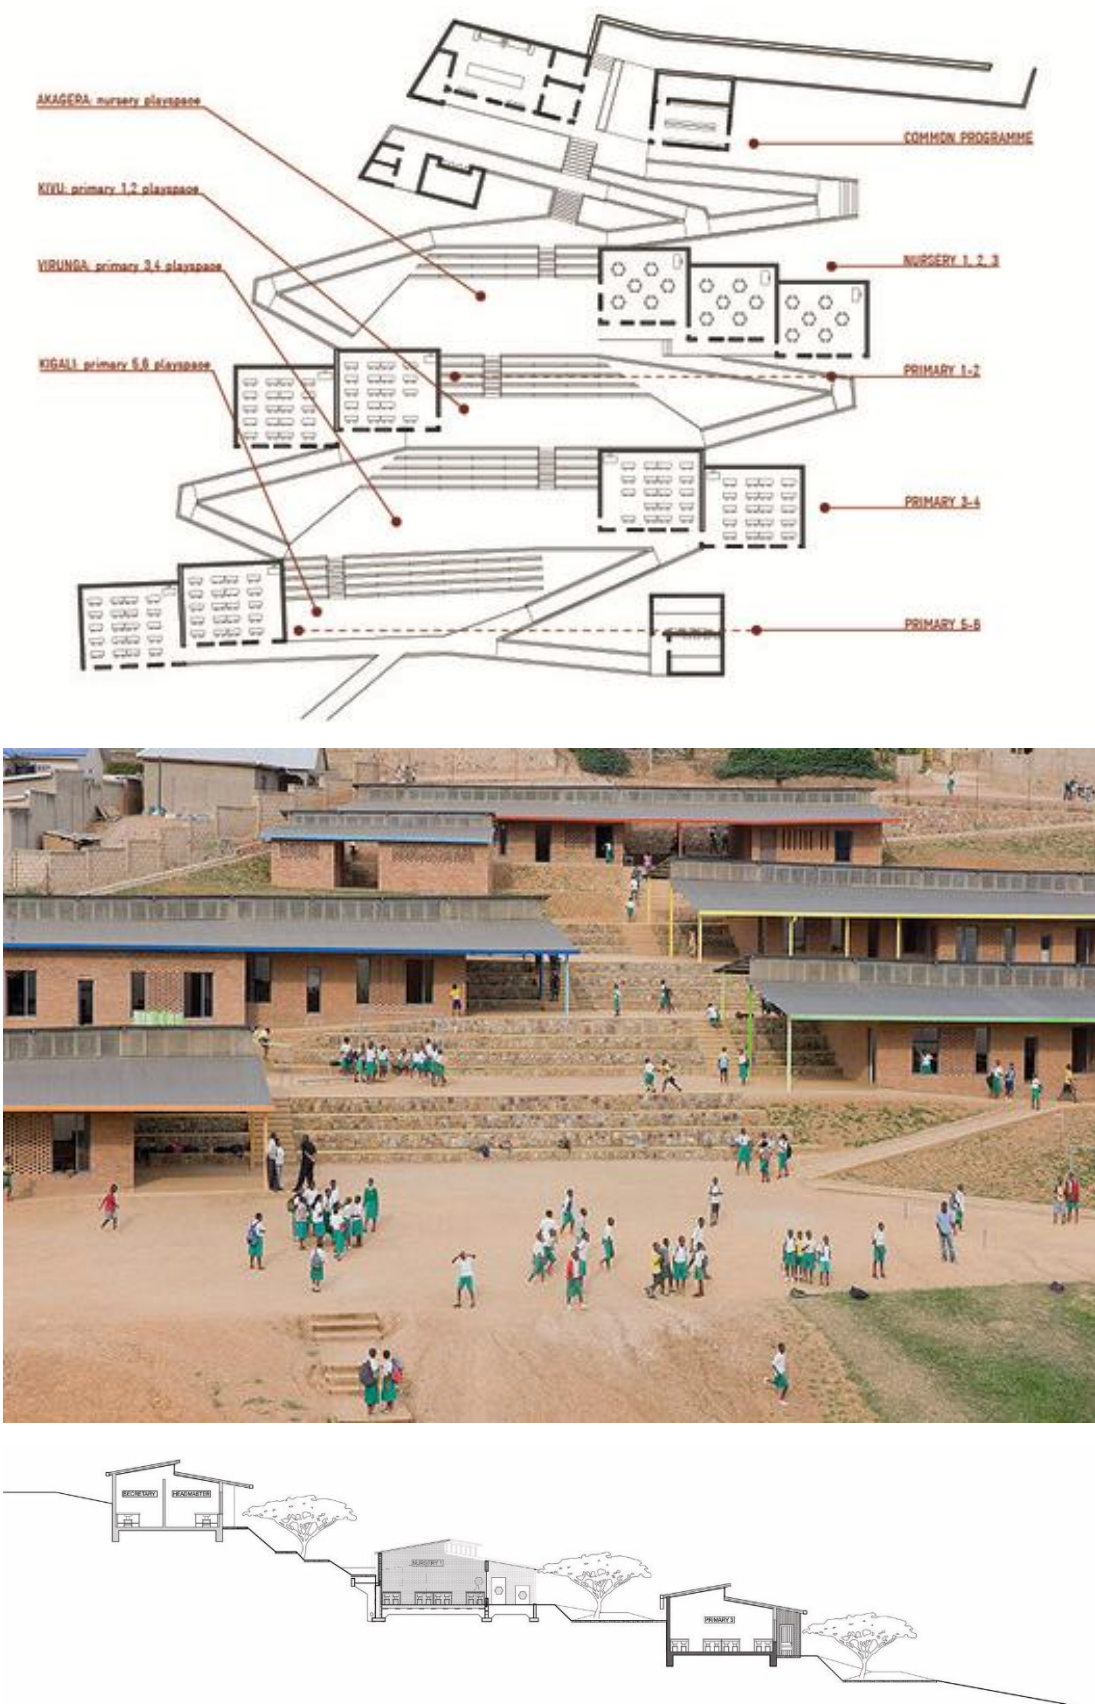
,48,49 | PLANTA, VISTA GERAL E, CORTE TRASNSVERSAL DA ESCOLA - KIGALI | IN: [WWW.ARCHDAILY.COM/](http://WWW.ARCHDAILY.COM/)
